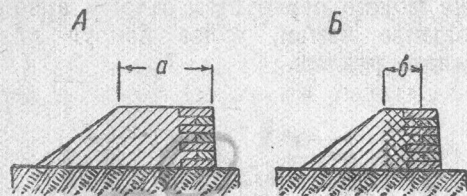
Брустверы и защитные толщи стен: А — из насыпного грунта; Б — из утрамбованного грунта
